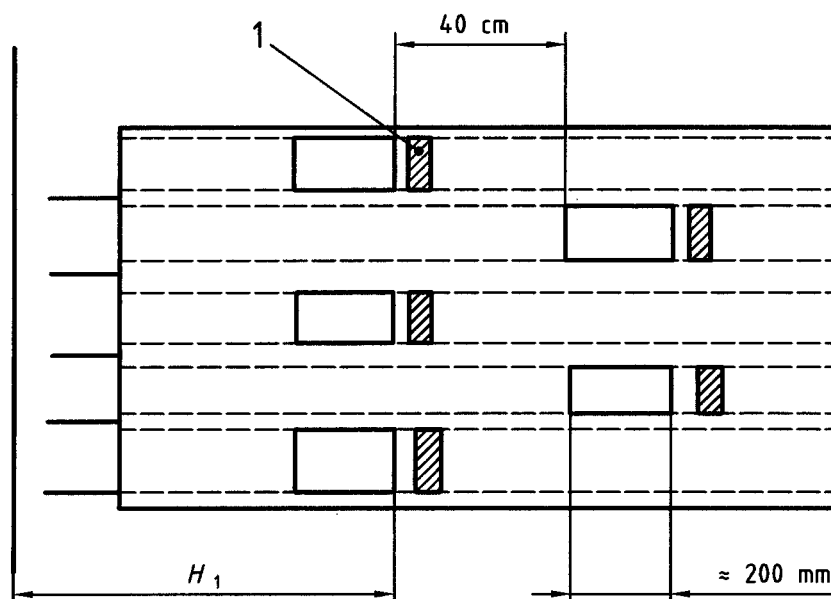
exemple de cas d'appui sur poutre dans les zones de retour
